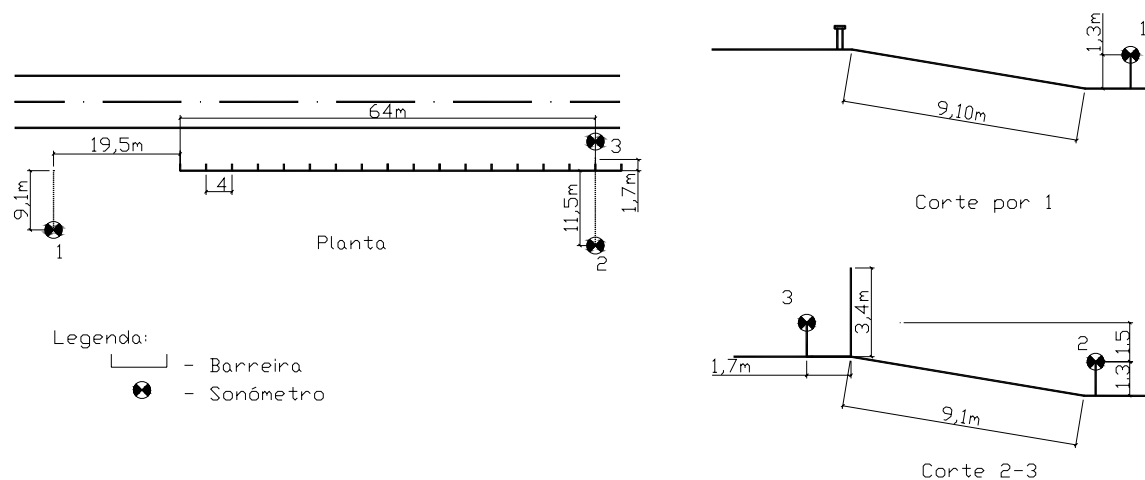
Localização dos equipamentos de medição em planta e em corte no caso de estudo 2.
